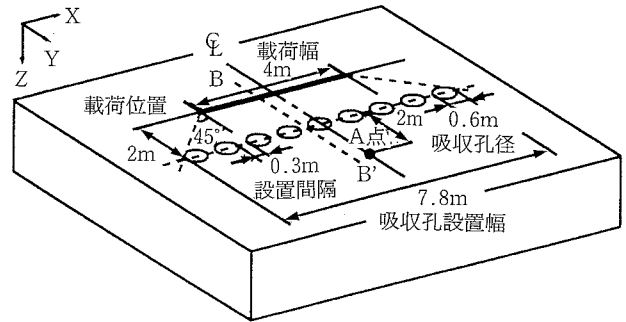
解析モデルの吸収孔周辺部（設置間隔 0.3 m）
